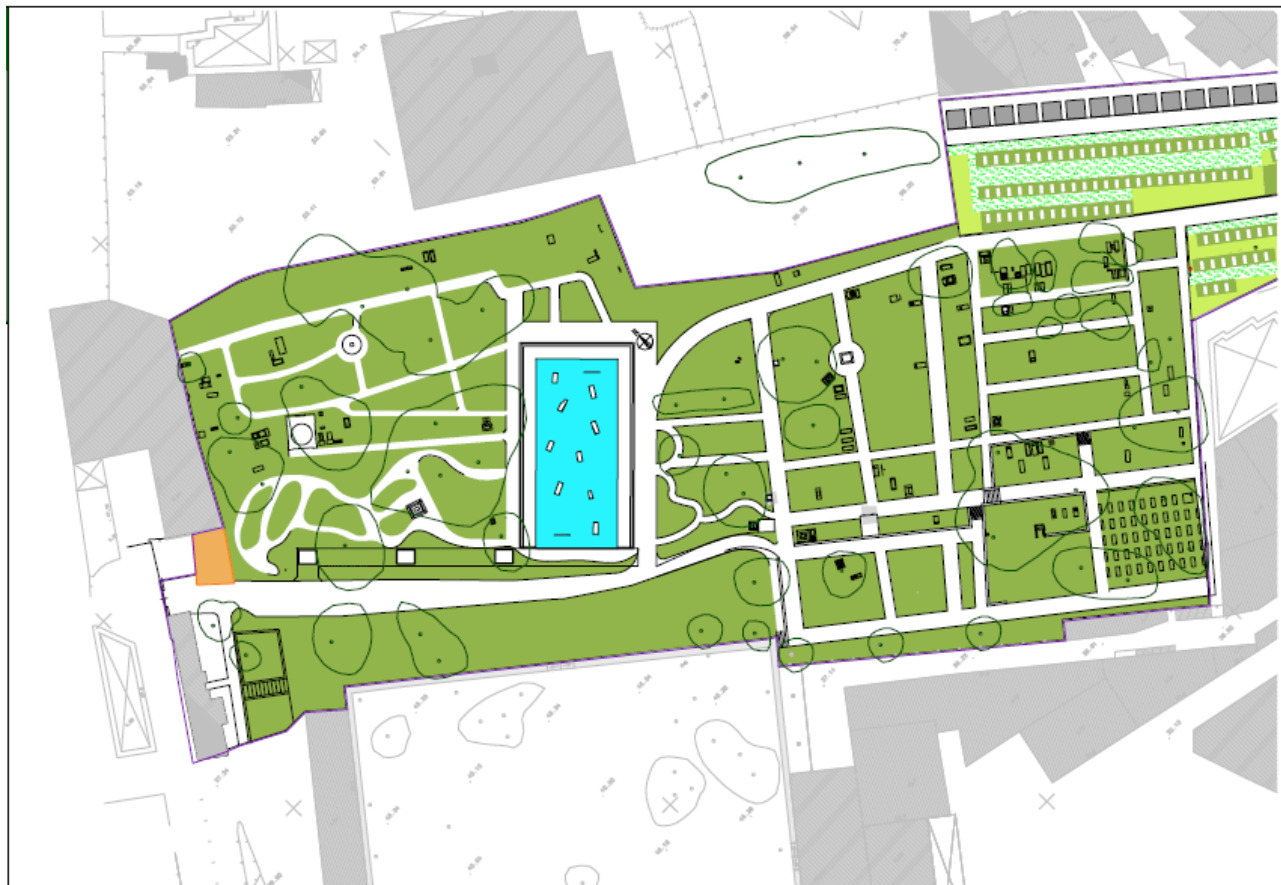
Progetto Preliminare - Pianta area ex Colerici
